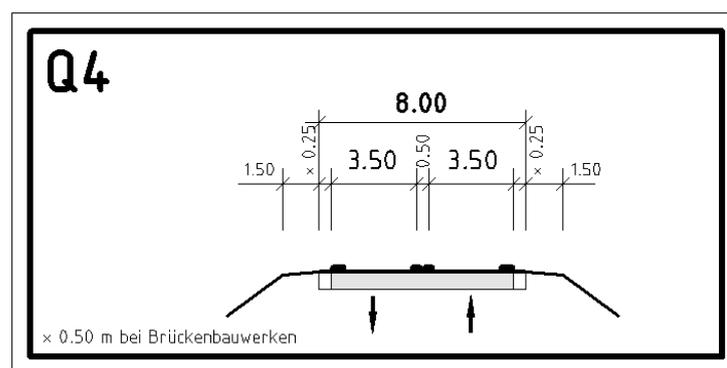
Rampenquerschnitt Q 4 [RAA - 2008; Bild 53]
